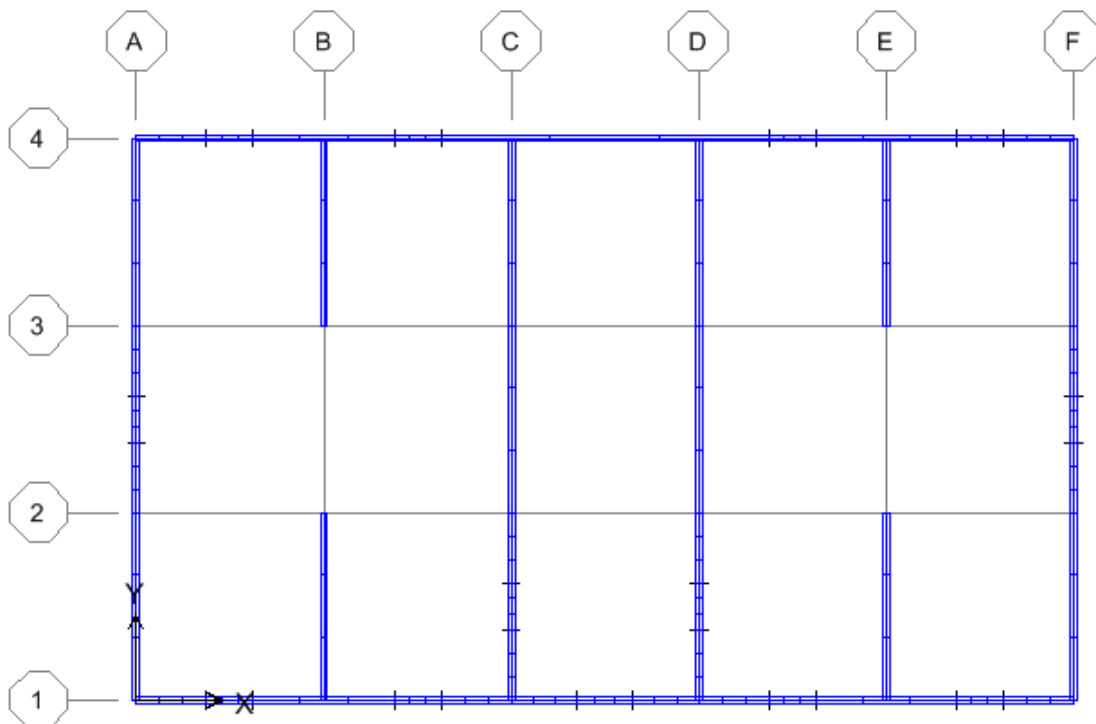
Disposition des voiles porteurs de la structure en (R+4)
